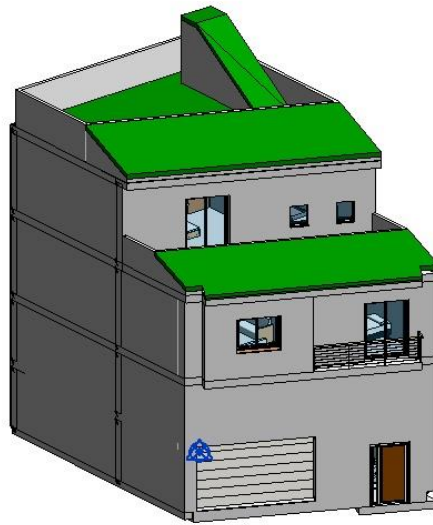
Vista 3D modelo LOD 100. Fuente: Propia (2019)
